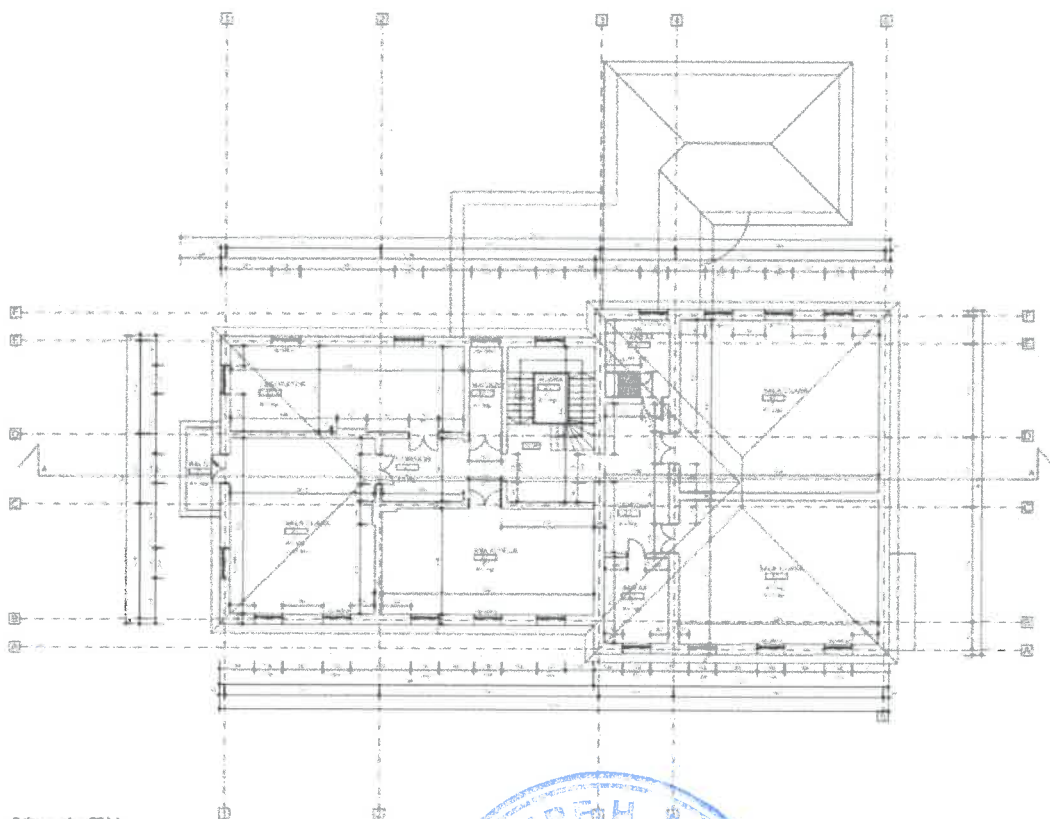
Plan subsol – existent (relevéu arhitectura)
